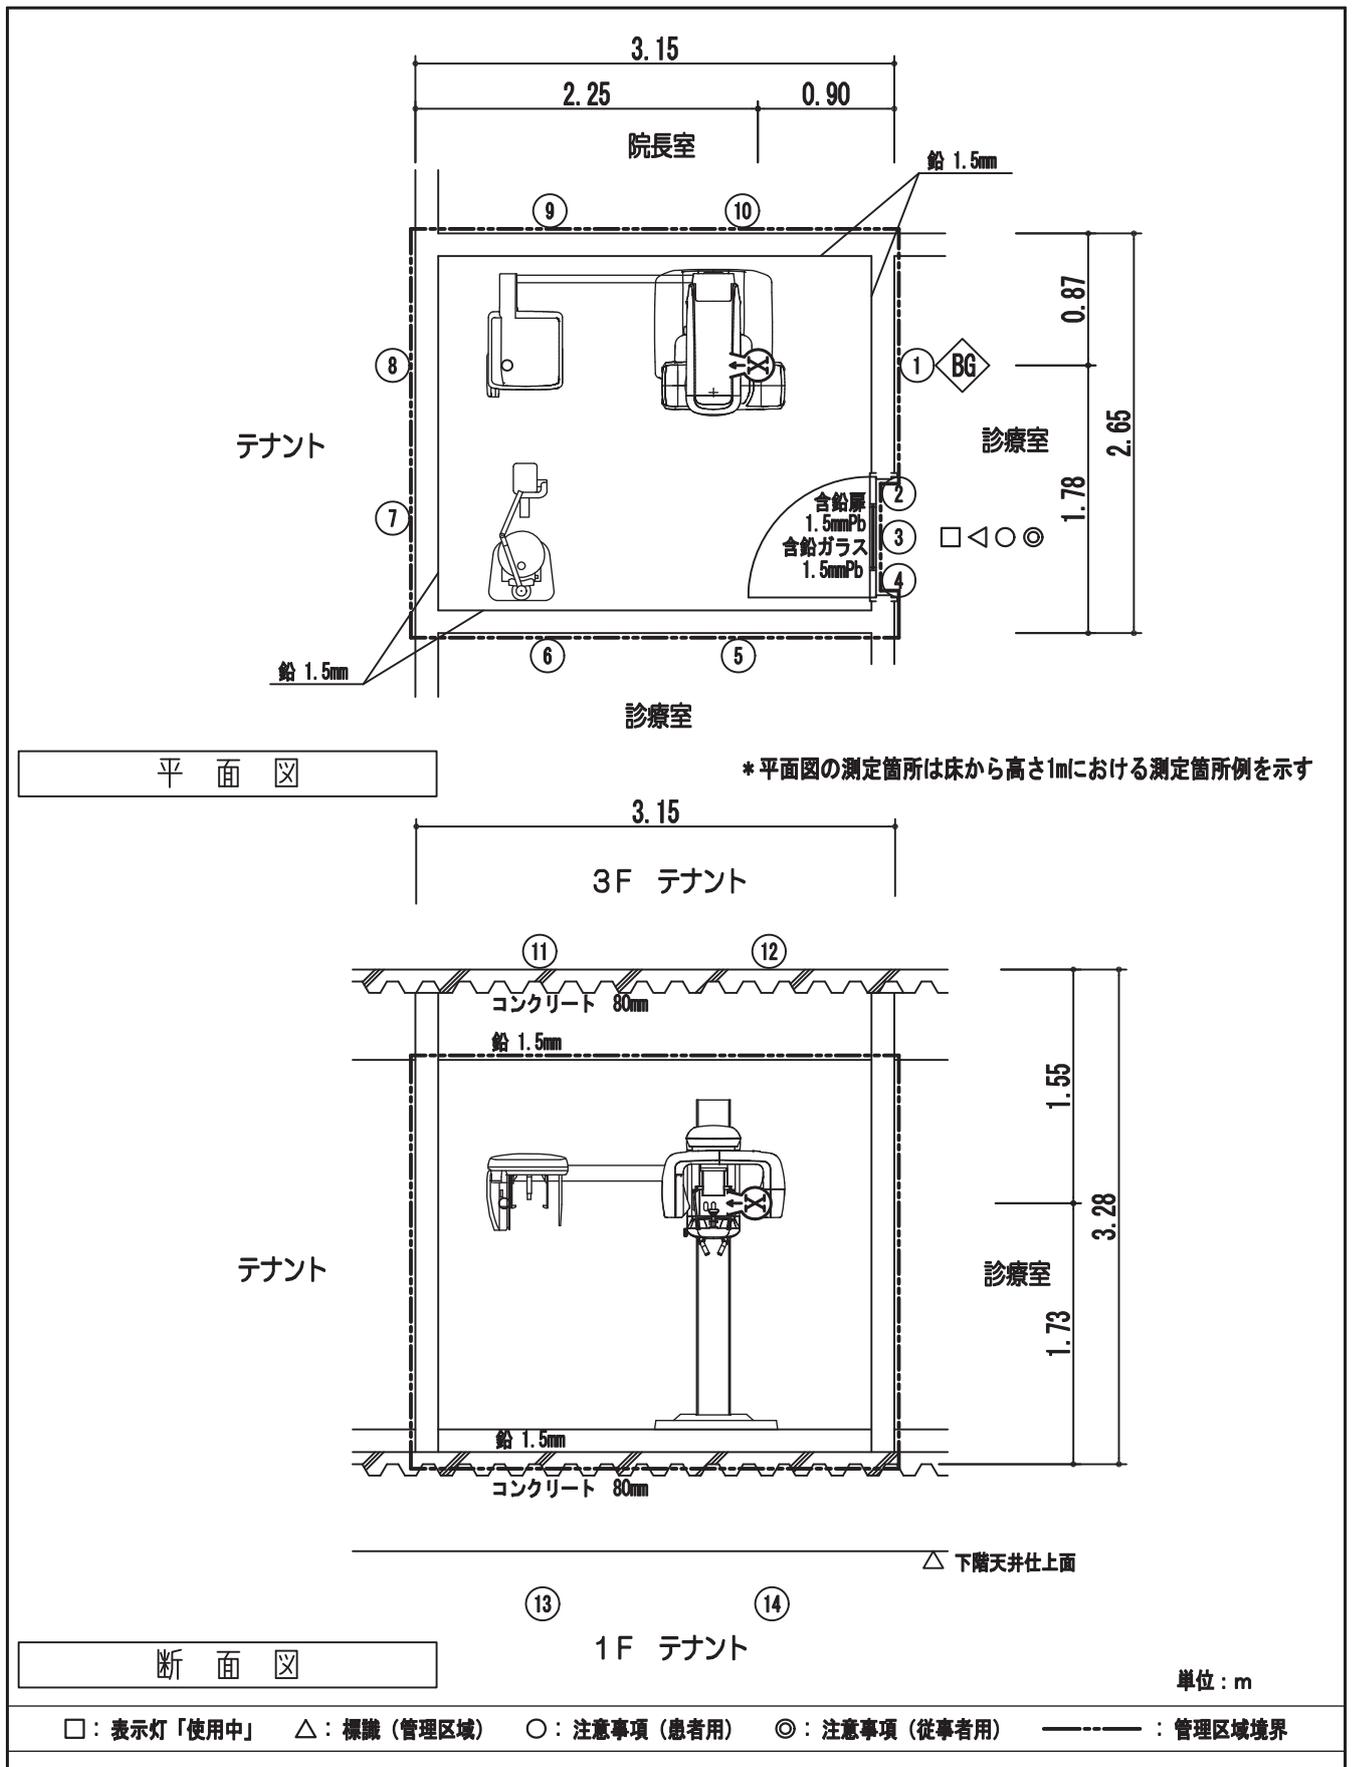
歯科用X線装置 セファロ撮影 平面図・断面図
